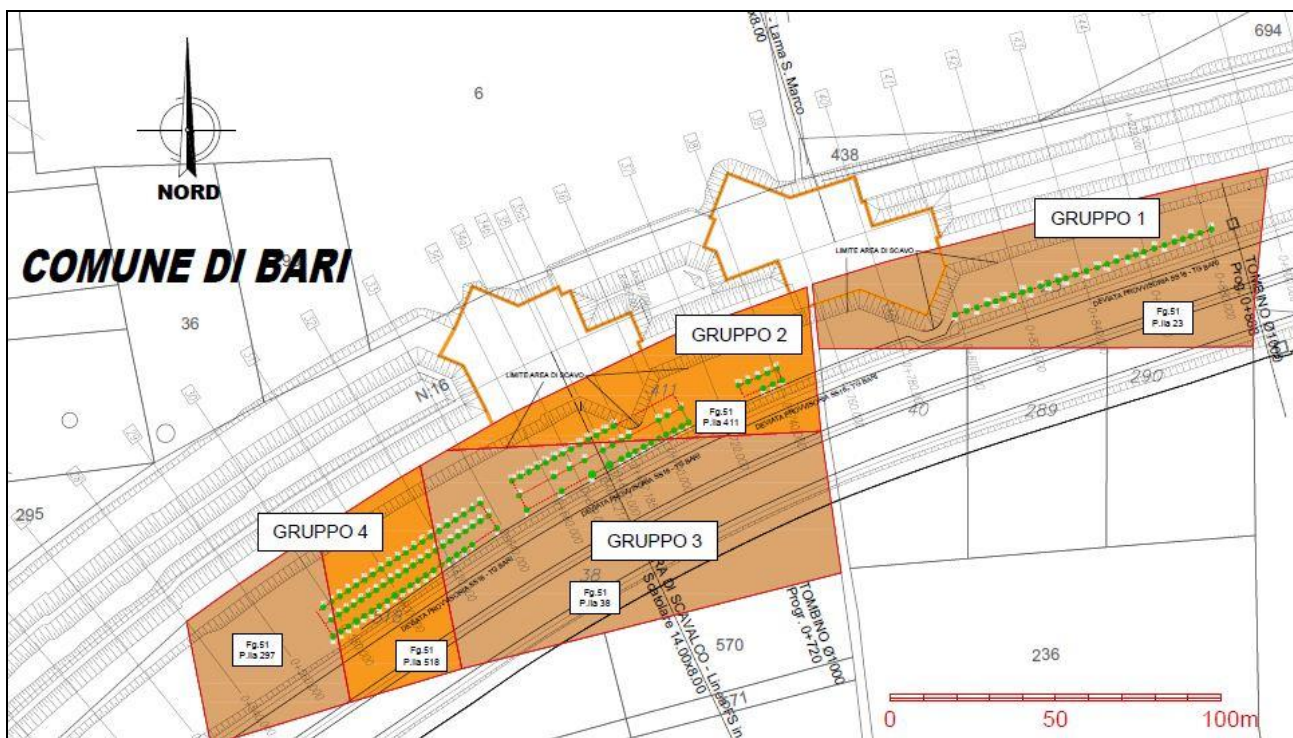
Planimetria della nuova disposizione degli ulivi secondo i 4 nuovi Gruppi
